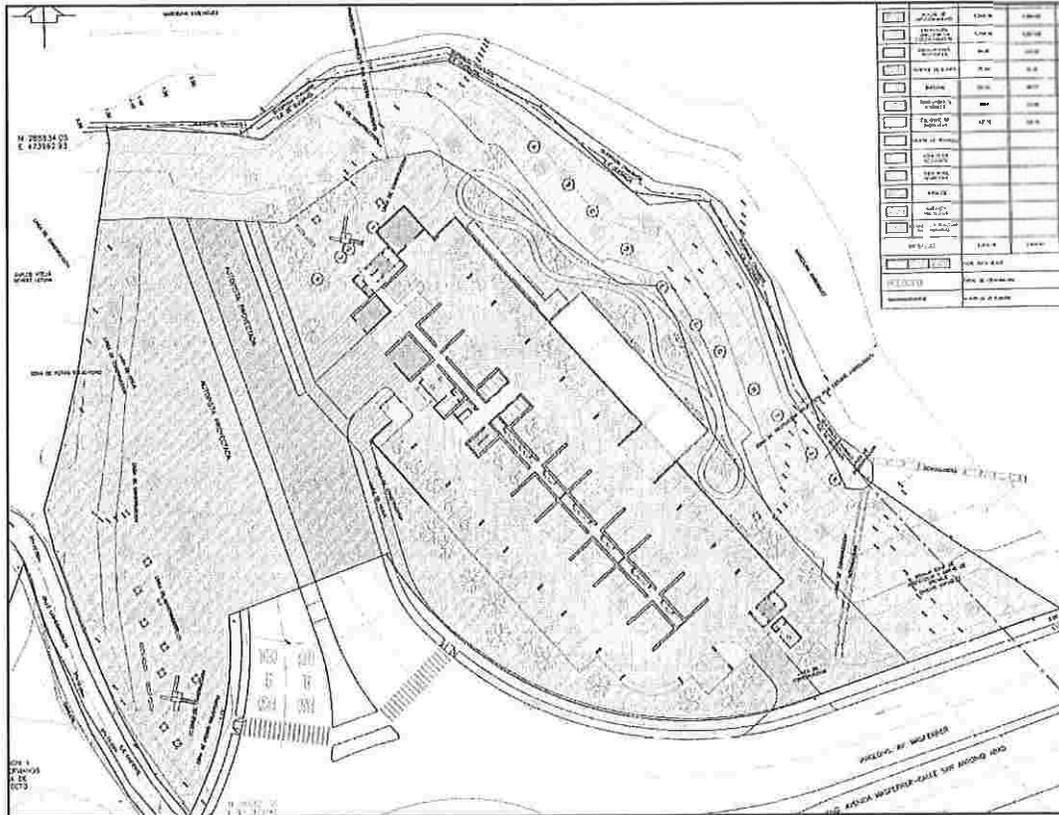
Áreas del Proyecto – Fuente: Plano de Revisión Vial
